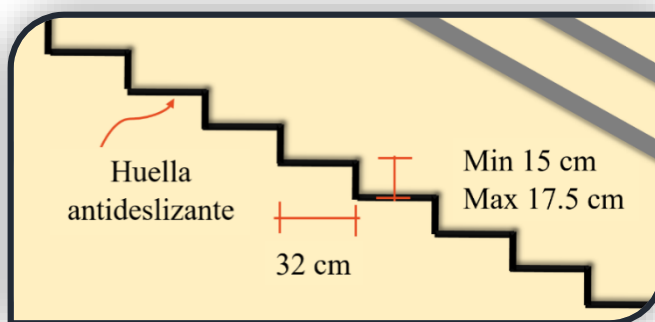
Vista en elevación lateral del detalle de medidas de las gradas en escaleras de la pasarela.
